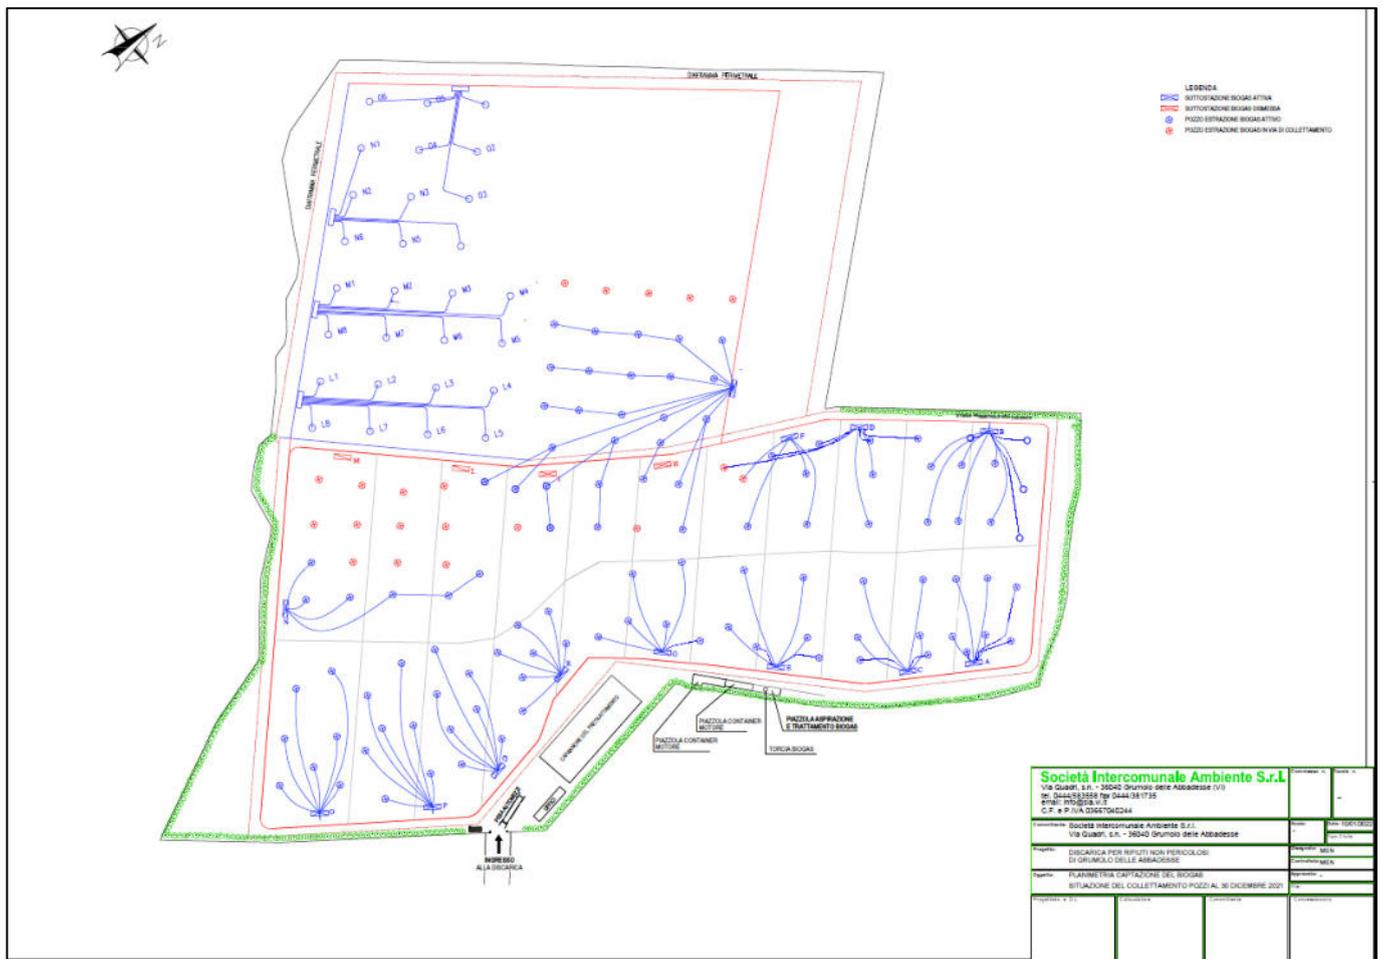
Planimetria stato di fatto impianto di captazione biogas al 31/1/2022
